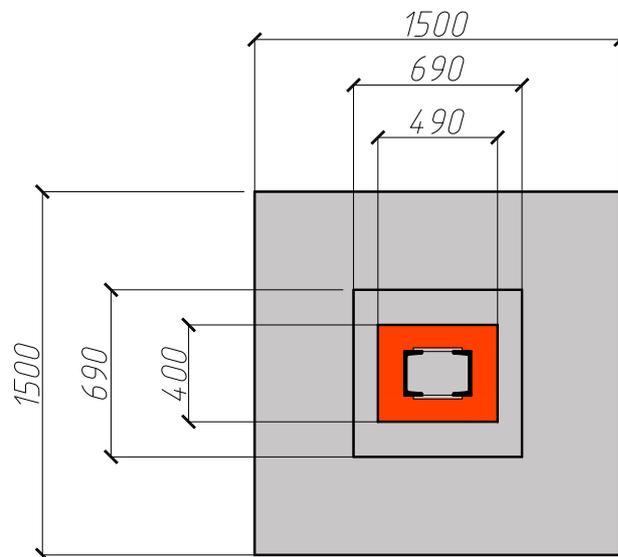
Эскиз поперечного сечения и план фундамента
